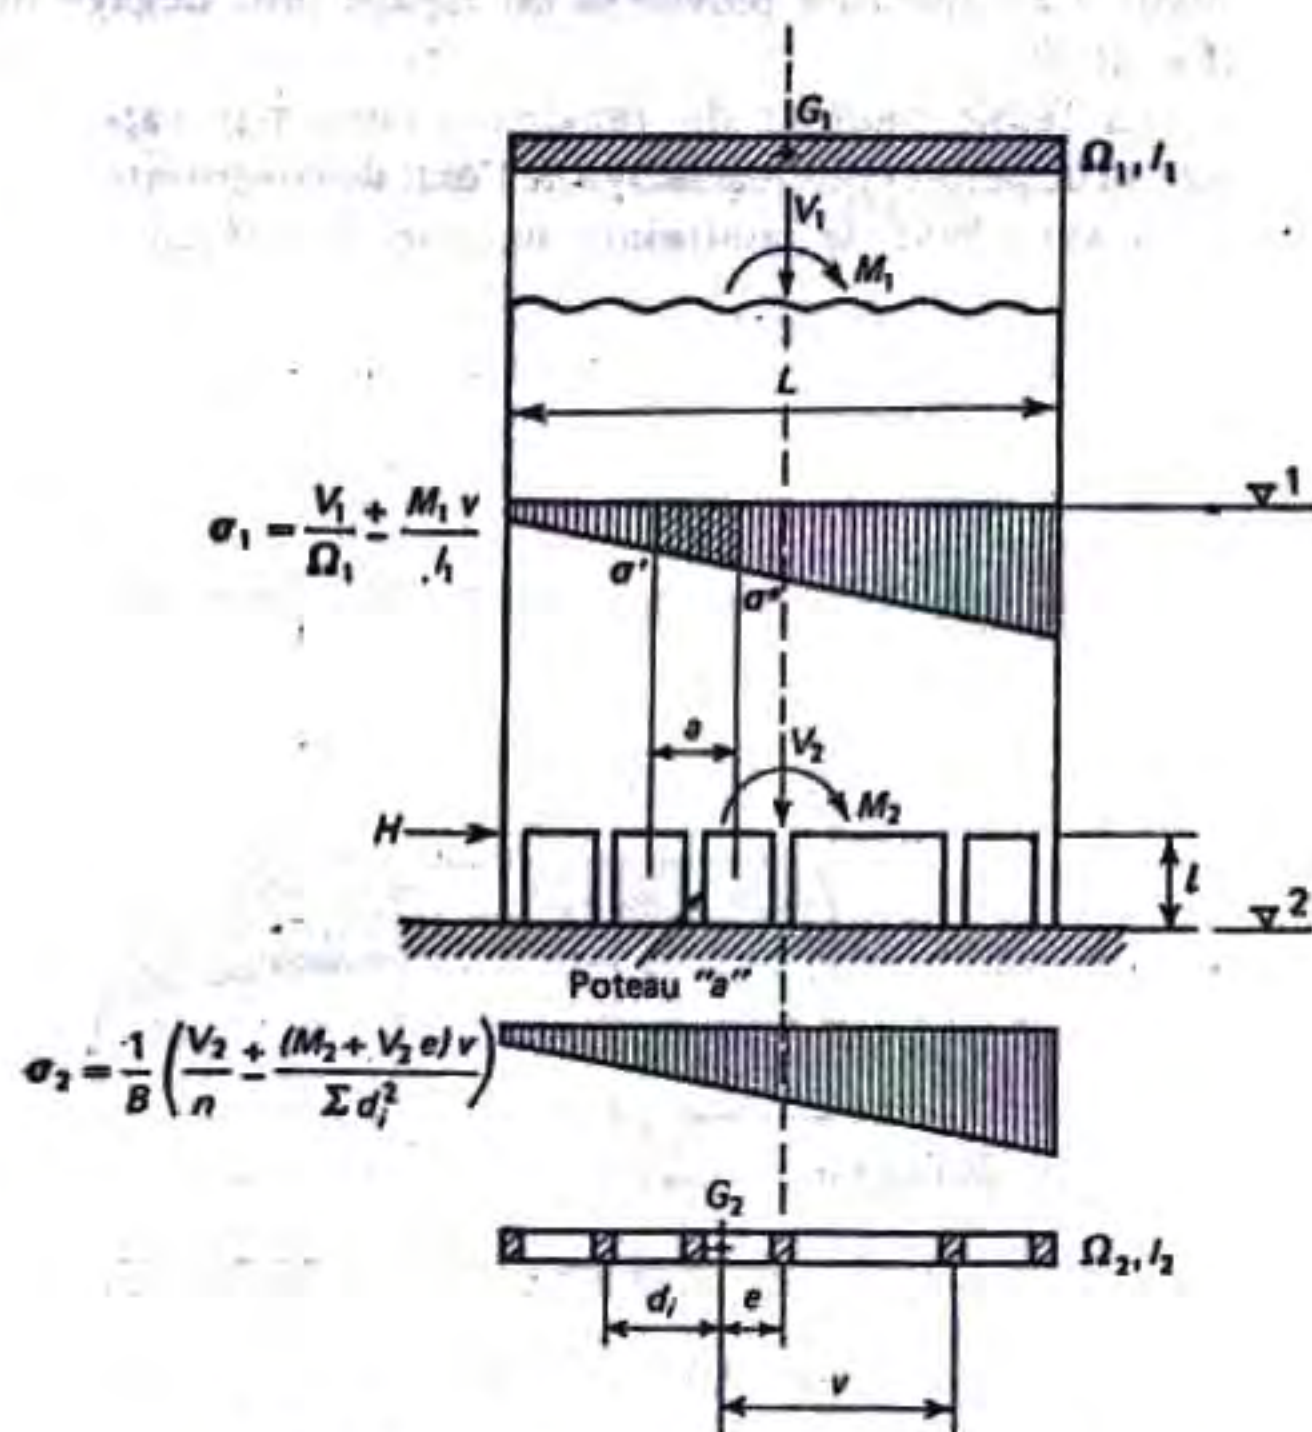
Poteaux au rez-de-chaussée.
